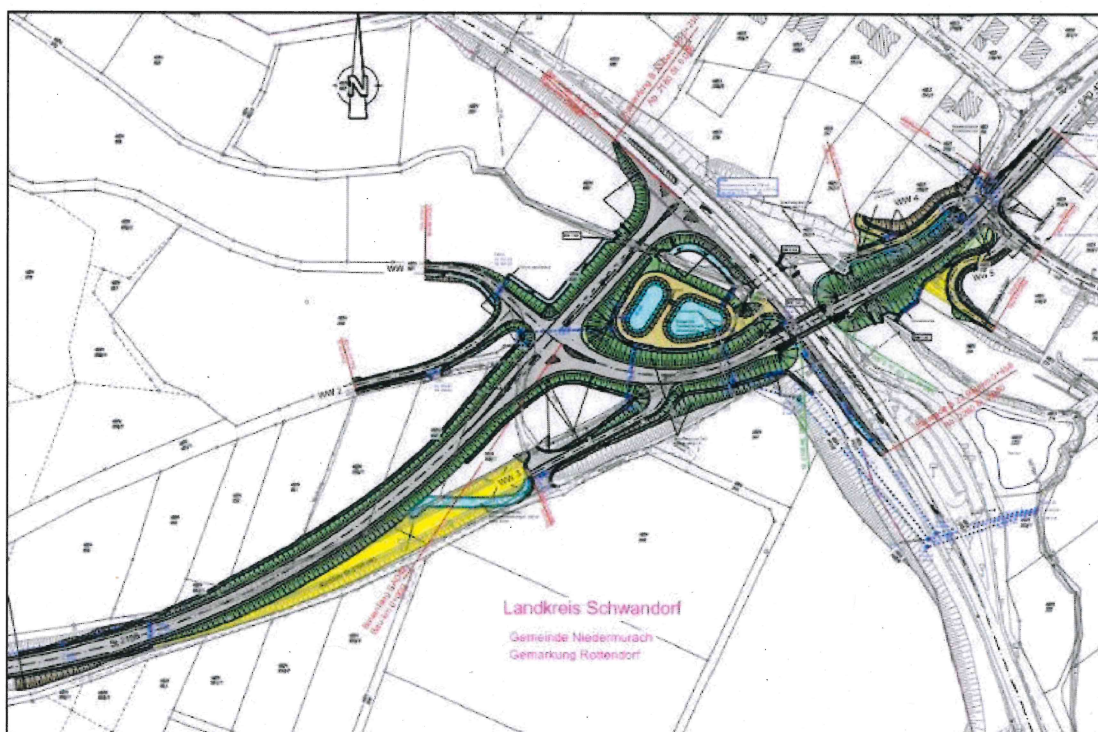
Umbau der Kreuzung der B22 mit der St 2156 und der Kreisstraße SAD 42 bei der Ortschaft Teunz (Landkreis Amberg-Sulzbach, Regierungsbezirk Ober-pfalz): Geplanter Trassenverlauf mit technischen Bauwerken Quelle: StBA Am-berg-Sulzbach Fachbereich Straßenbau
